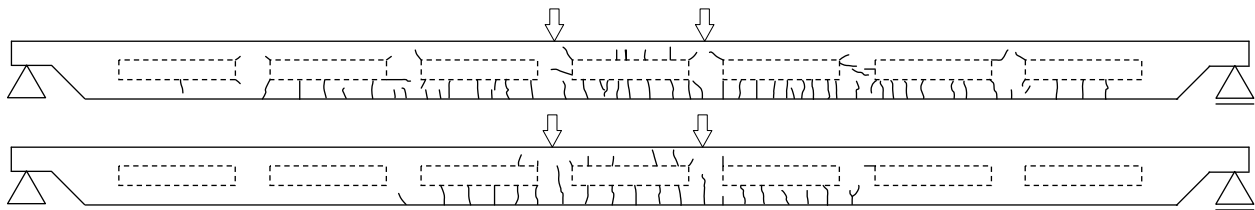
短期載荷終了時ひび割れ状況(上段: 軽量コンクリート, 下段: 普通コンクリート)
